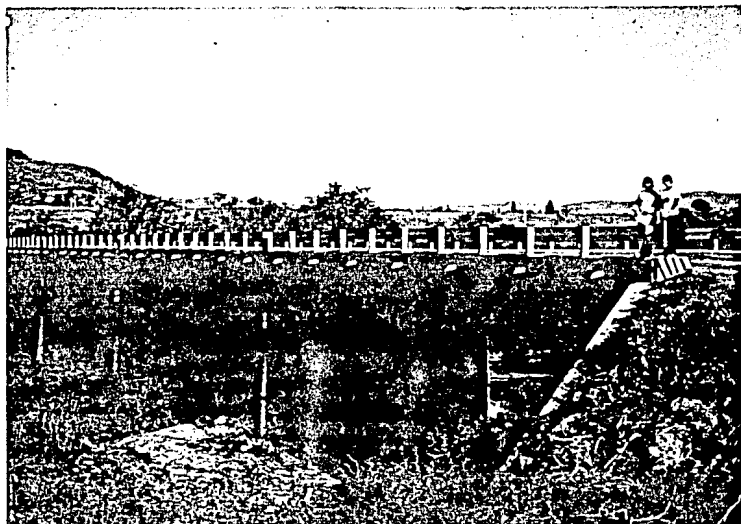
VISTA SUR DEL PUENTE TOTALMENTE TERMINADO.
